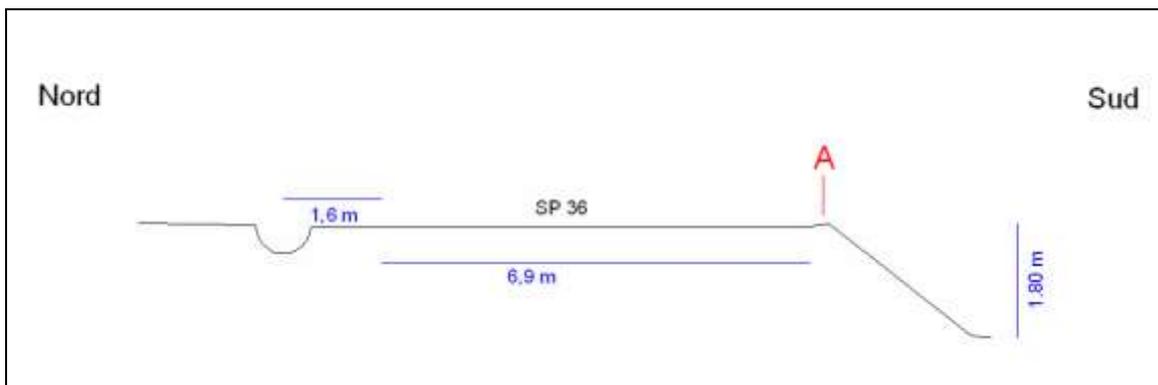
Sezione schematica del tratto stradale di interesse (SP36)
